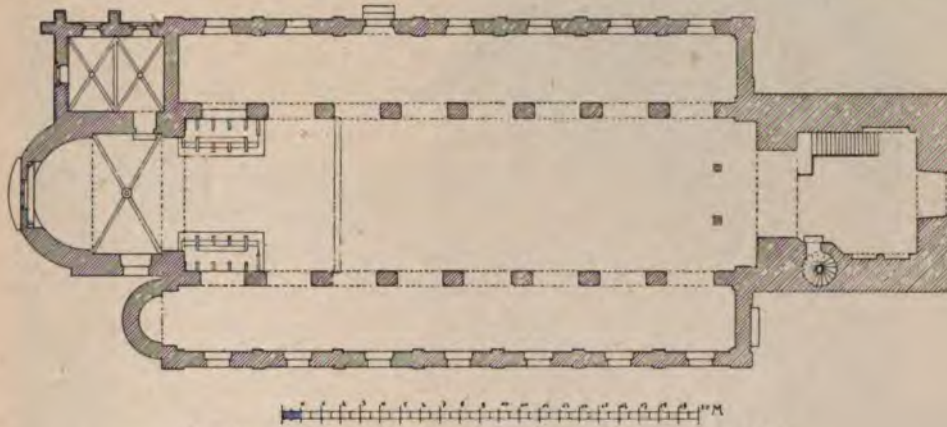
Wassenberg, Grundriss der kath. Pfarrkirche.
